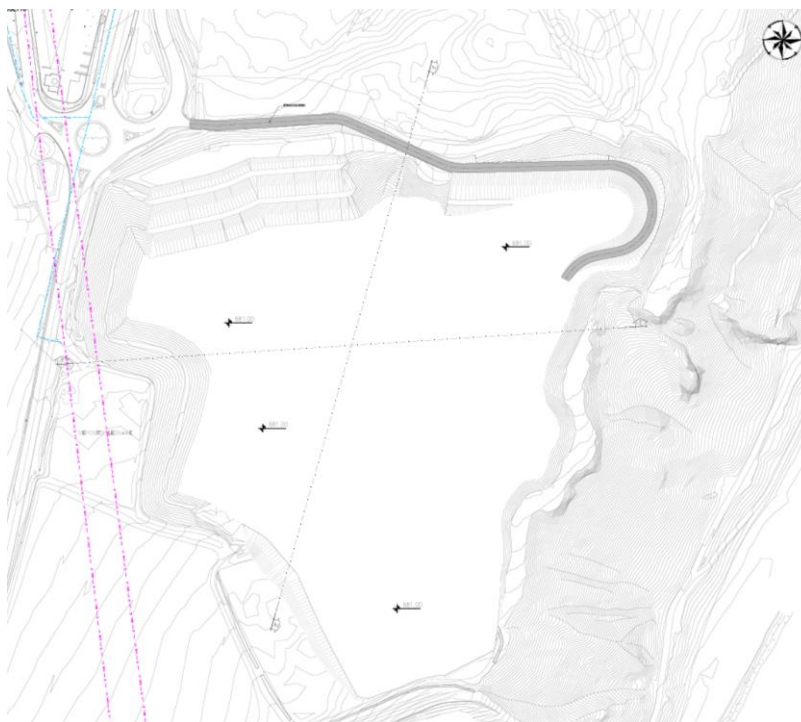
Stralcio planimetrico della cava esistente (“Cantiere Area Forch”, con estensione a Zone B – C)
